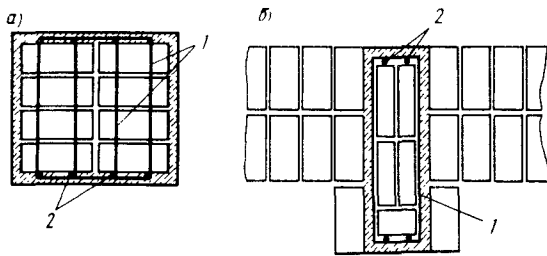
Продольное армирование кирпичных конструкций:
